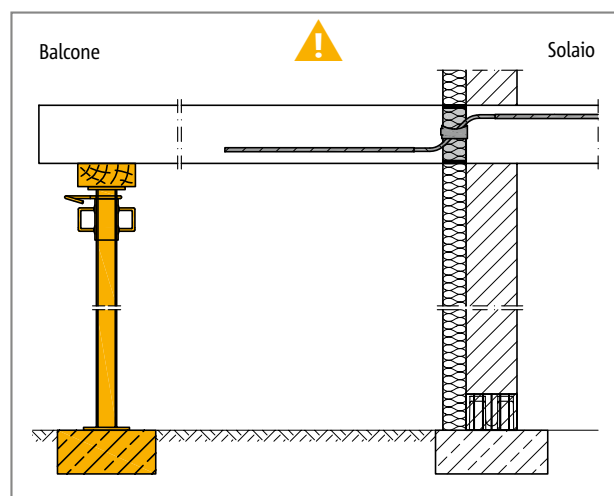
Schöck Isokorb® T tipo QP: è necessario un appoggio continuo
